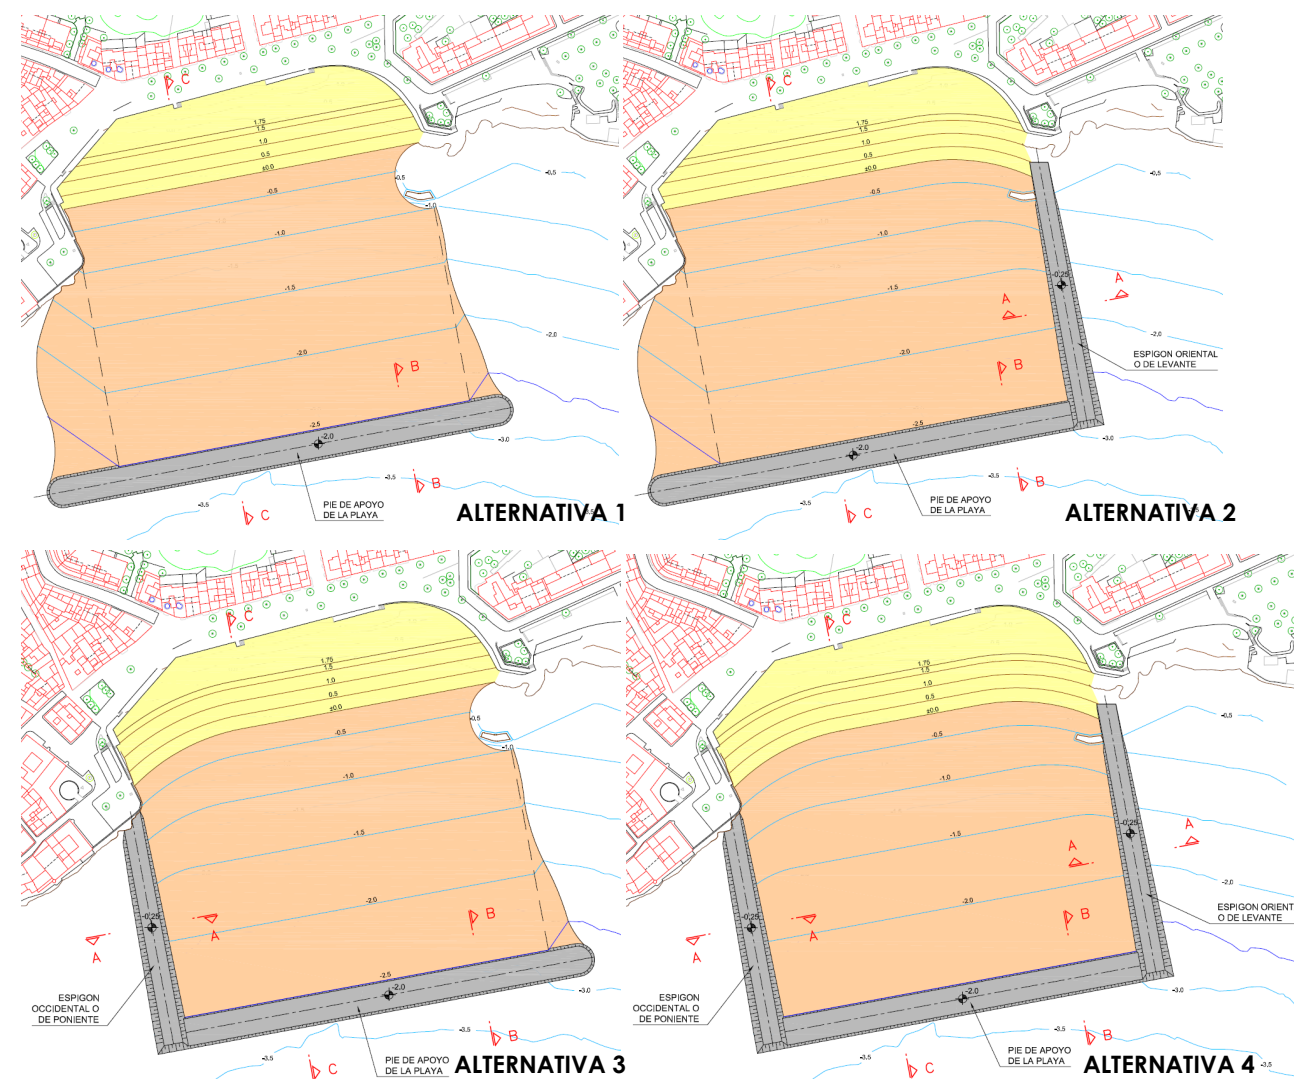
Planta de las alternativas inicialmente propuestas y sección tipo de la aportación de arena y del espigón de pie de apoyo (Fuente: Elaboración propia)
